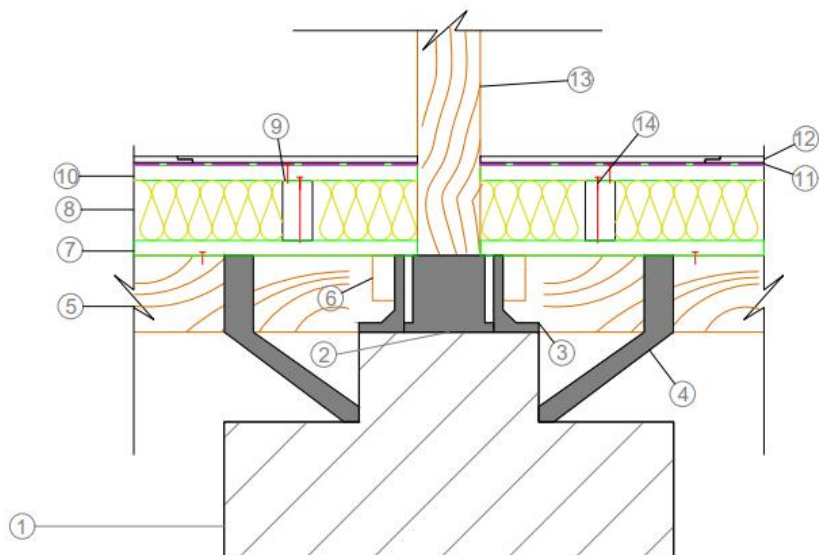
Pieza de unión de vigas principales de forjado con cimentación. www.indexfix.com
